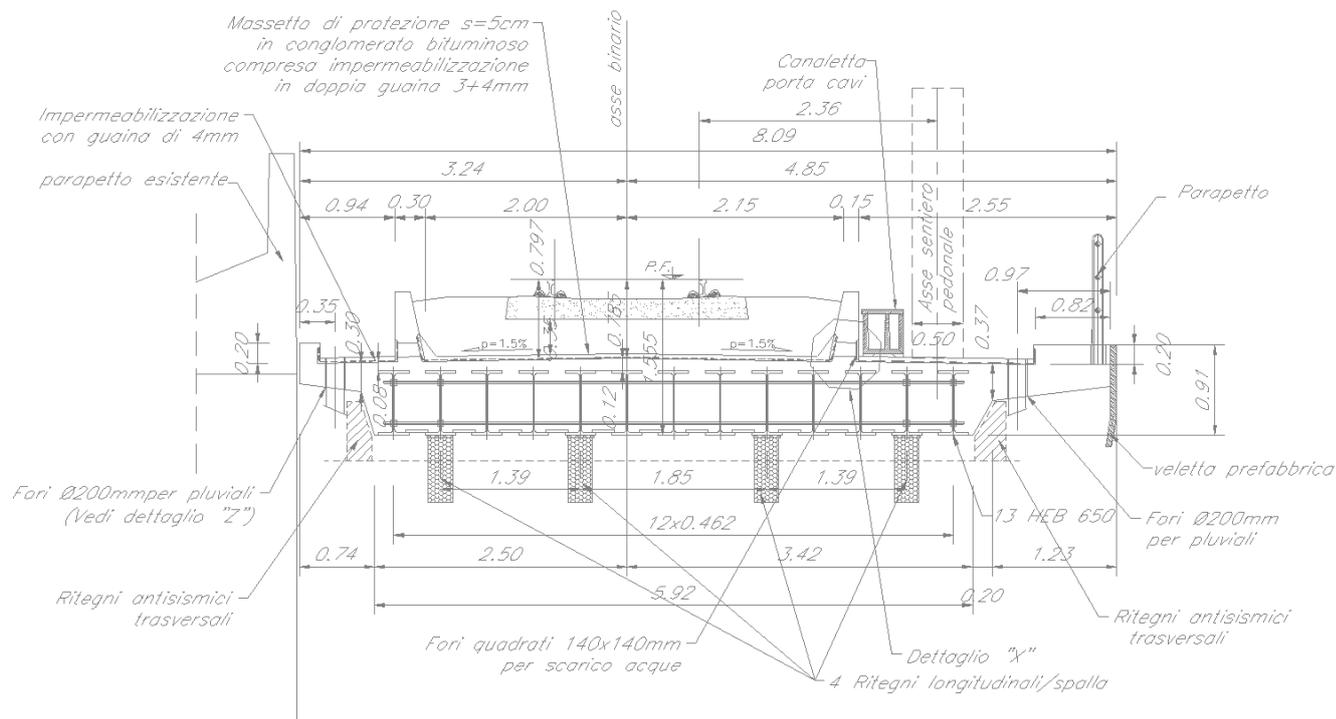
Sezione trasversale nuovo viadotto a travi incorporate
